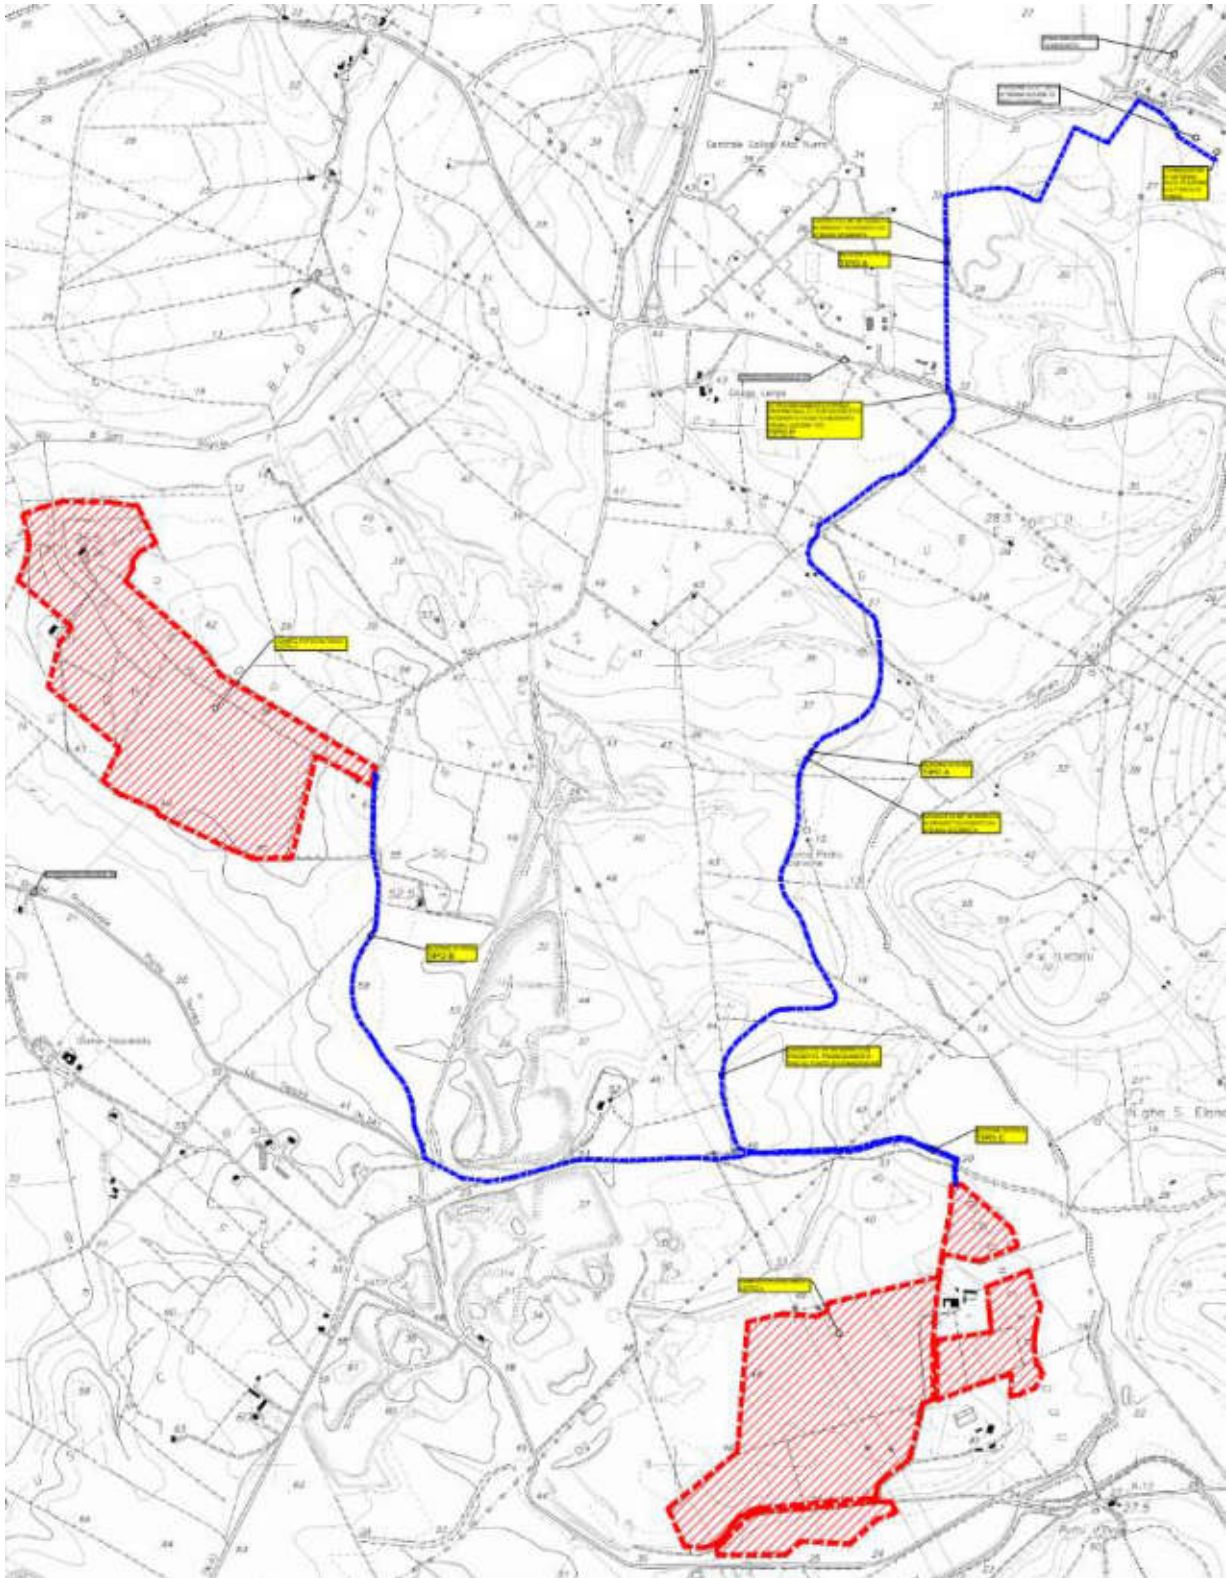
Tracciato del cavidotto di media tensione (in blu) per la connessione sulla rete elettrica nazionale (da elaborati di progetto)
